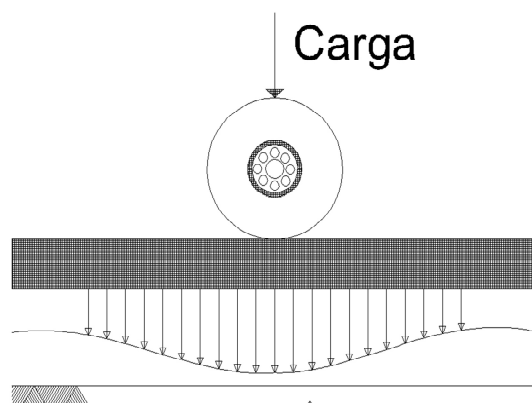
Distribuição de cargas em um pavimento rígido
